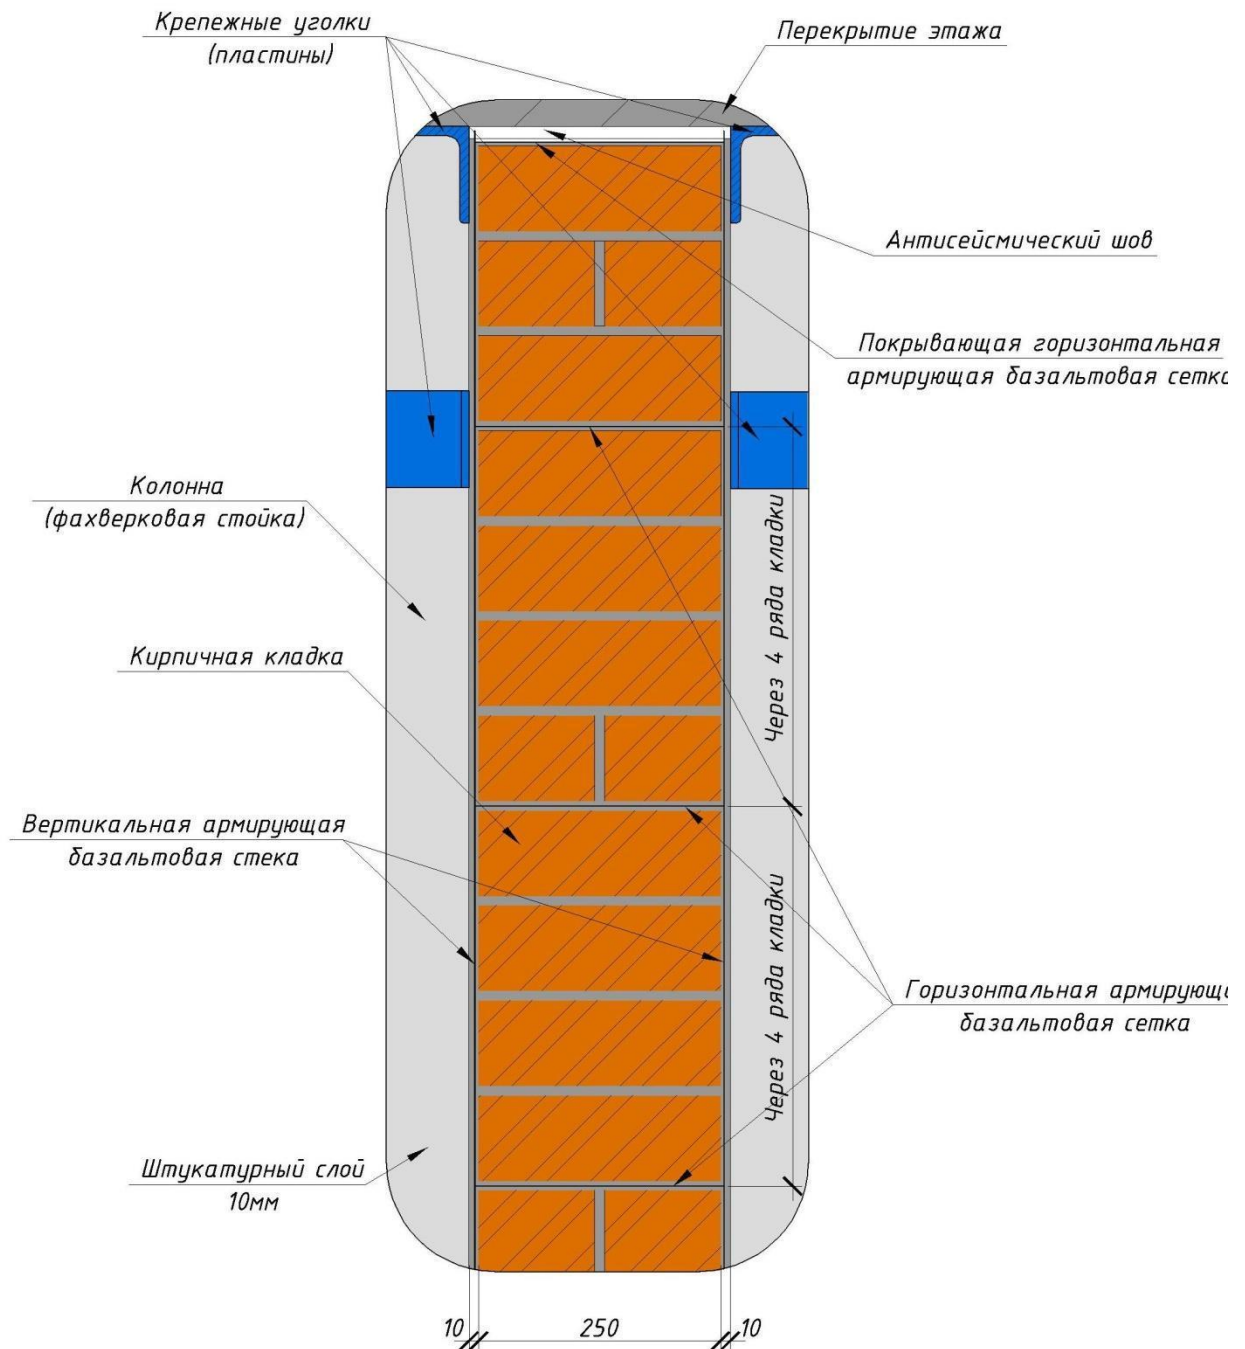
Схема крепления кирпичной перегородки, усиленной базальтовой сеткой, к каркасу здания (горизонтальное сечение)
